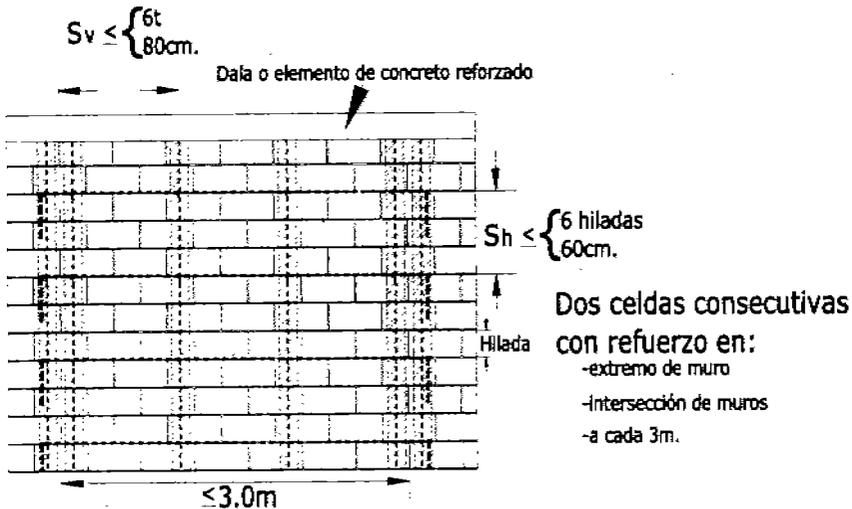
REFUERZO HORIZONTAL Y VERTICAL
